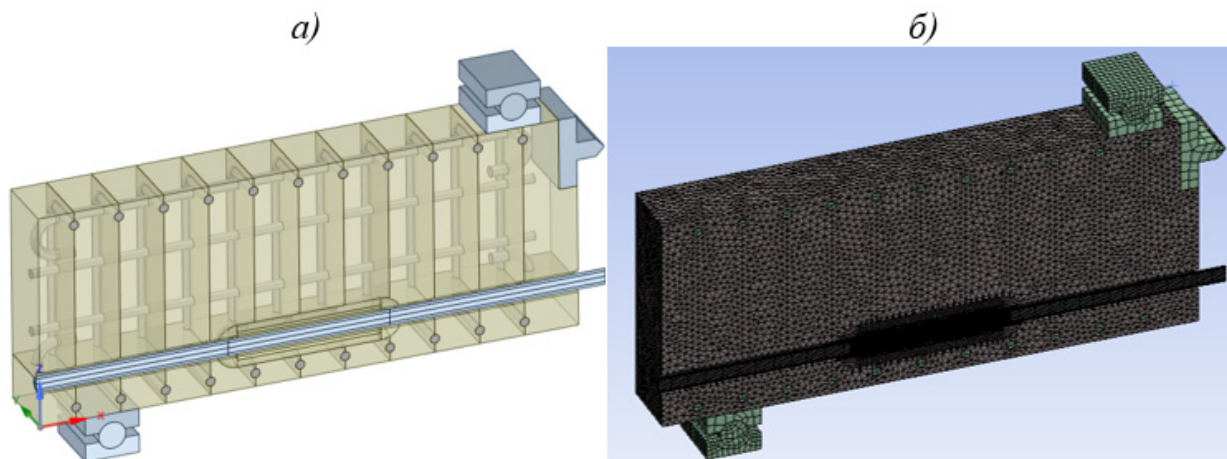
Твердотельная (а) и конечно-элементная модель (б) балочного образца конца балки
